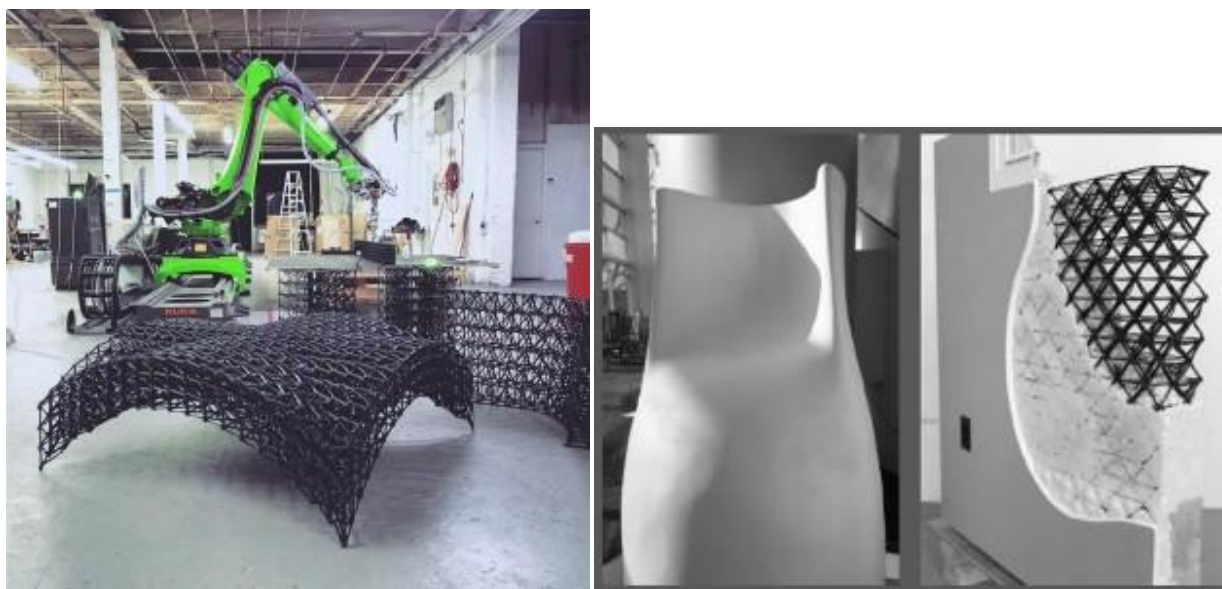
Метод 3D printing C-Fab [3]: а – неметаллический арматурный каркас; б – фрагмент стены
